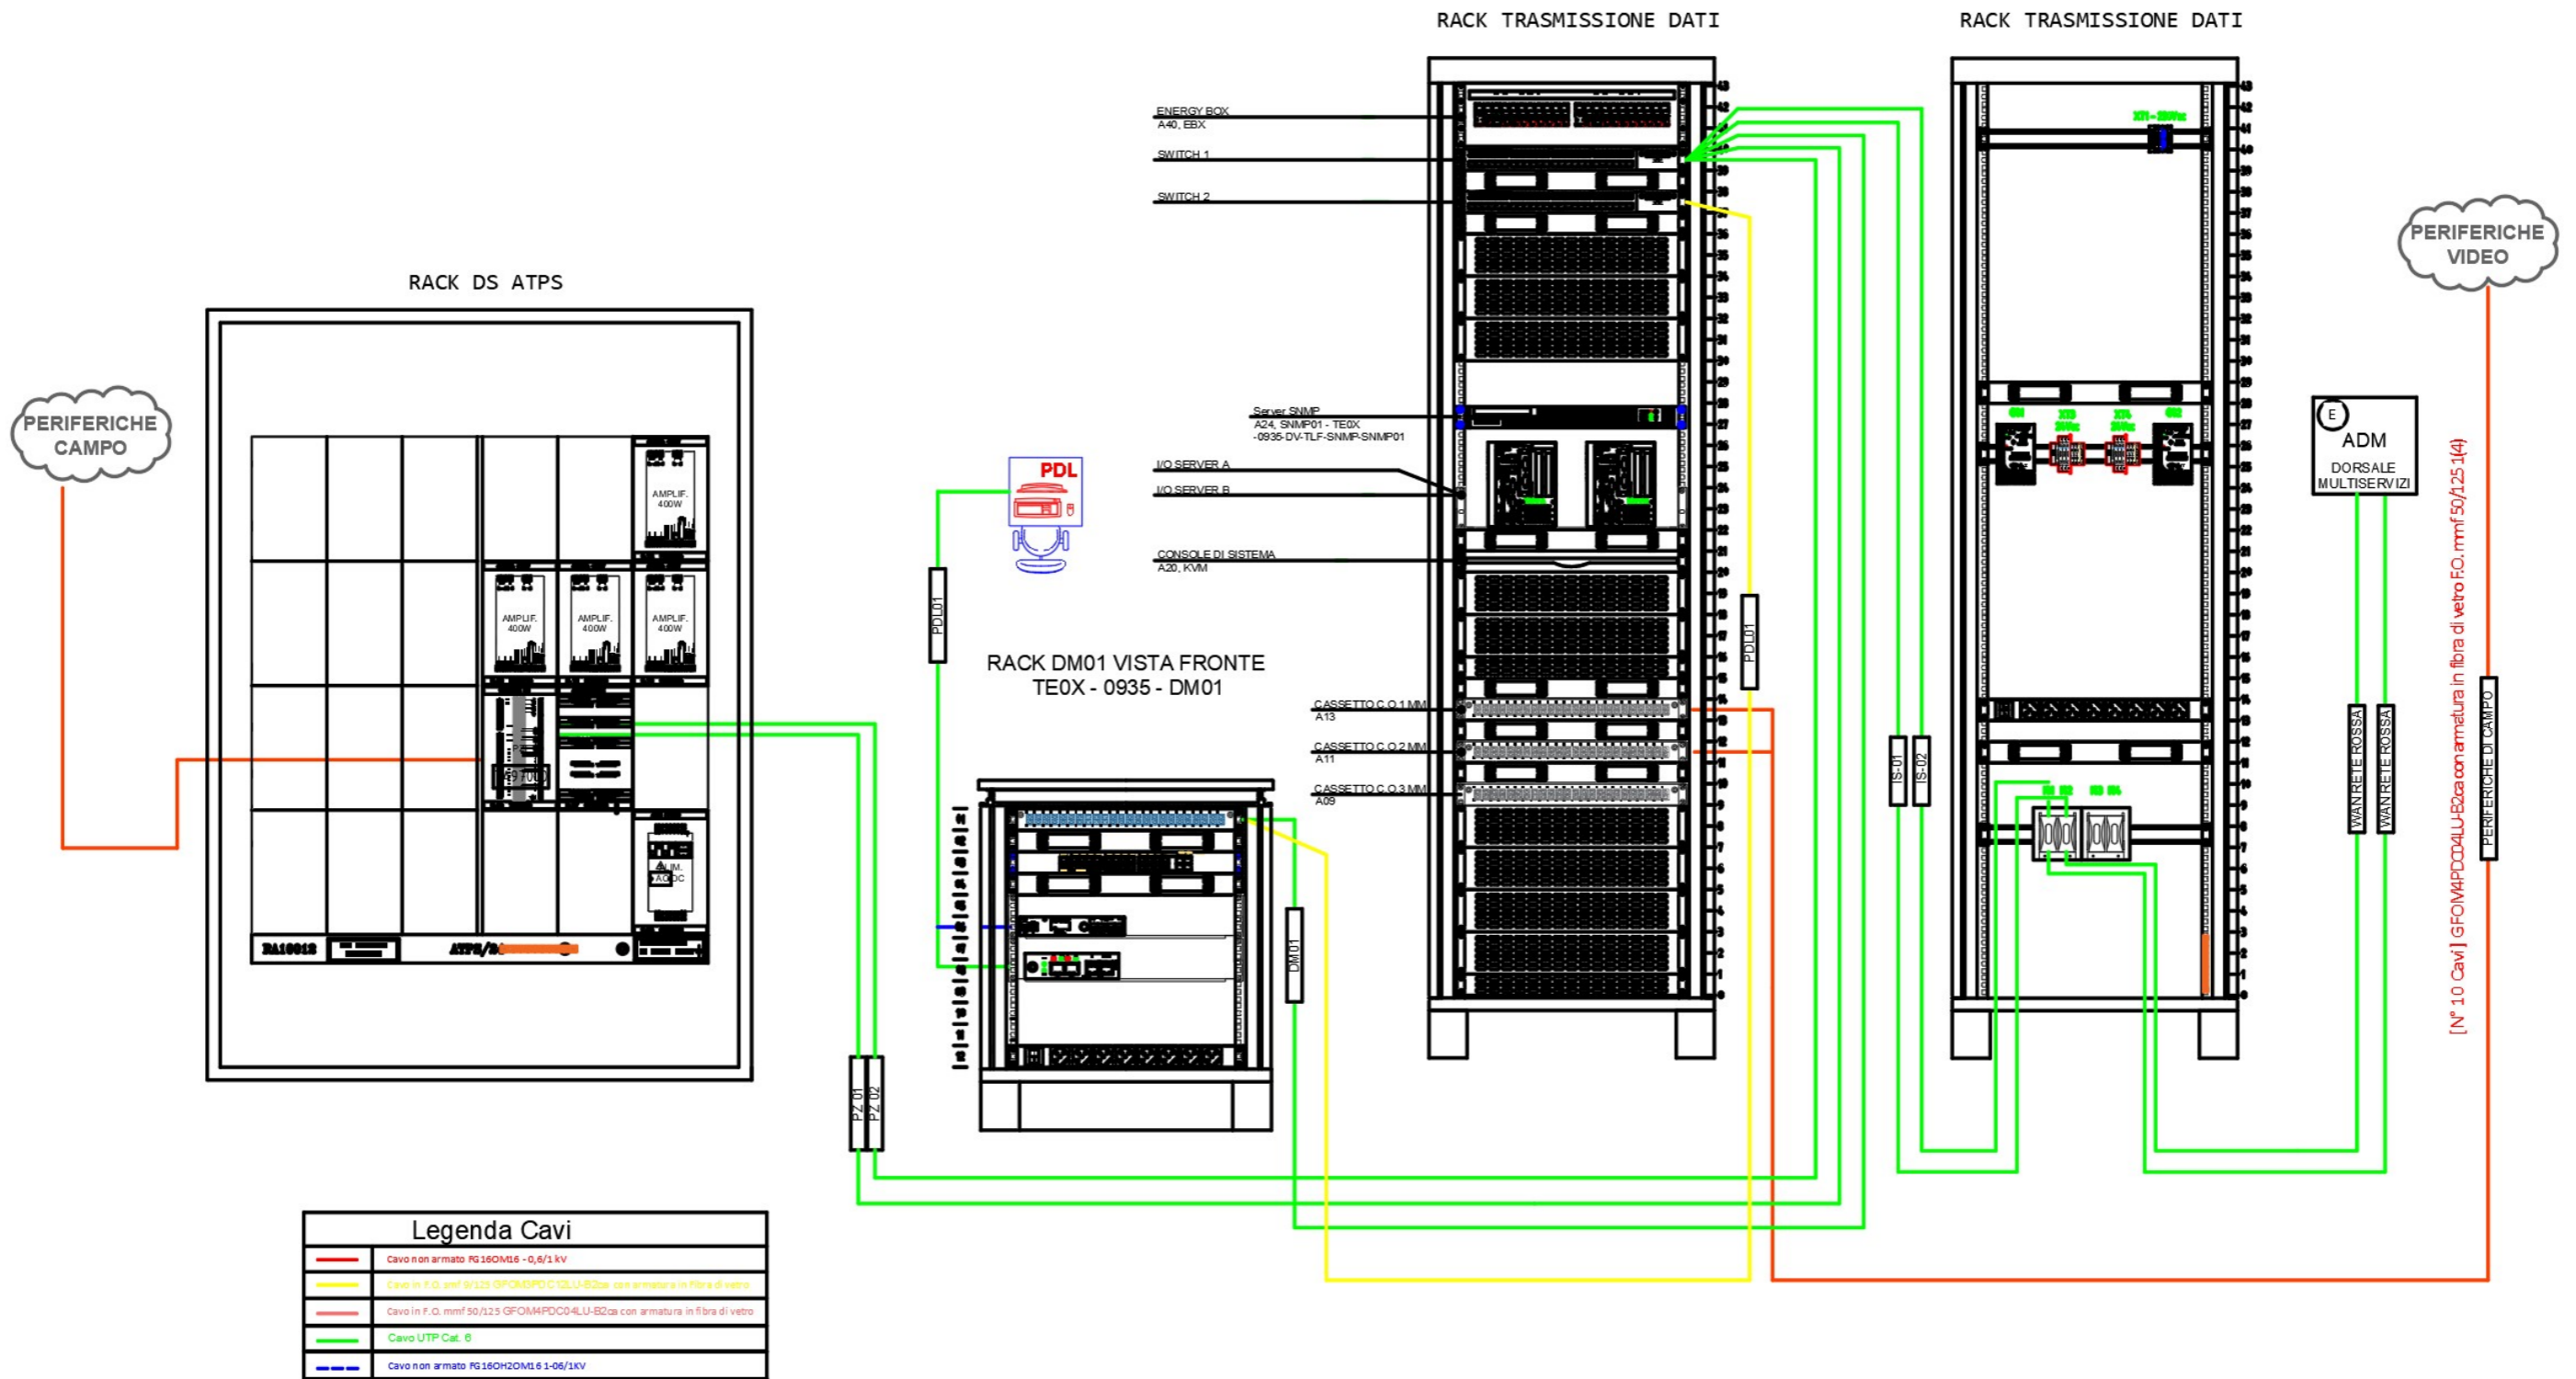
Architettura generale dell'impianto laP Ponte Casalduni
